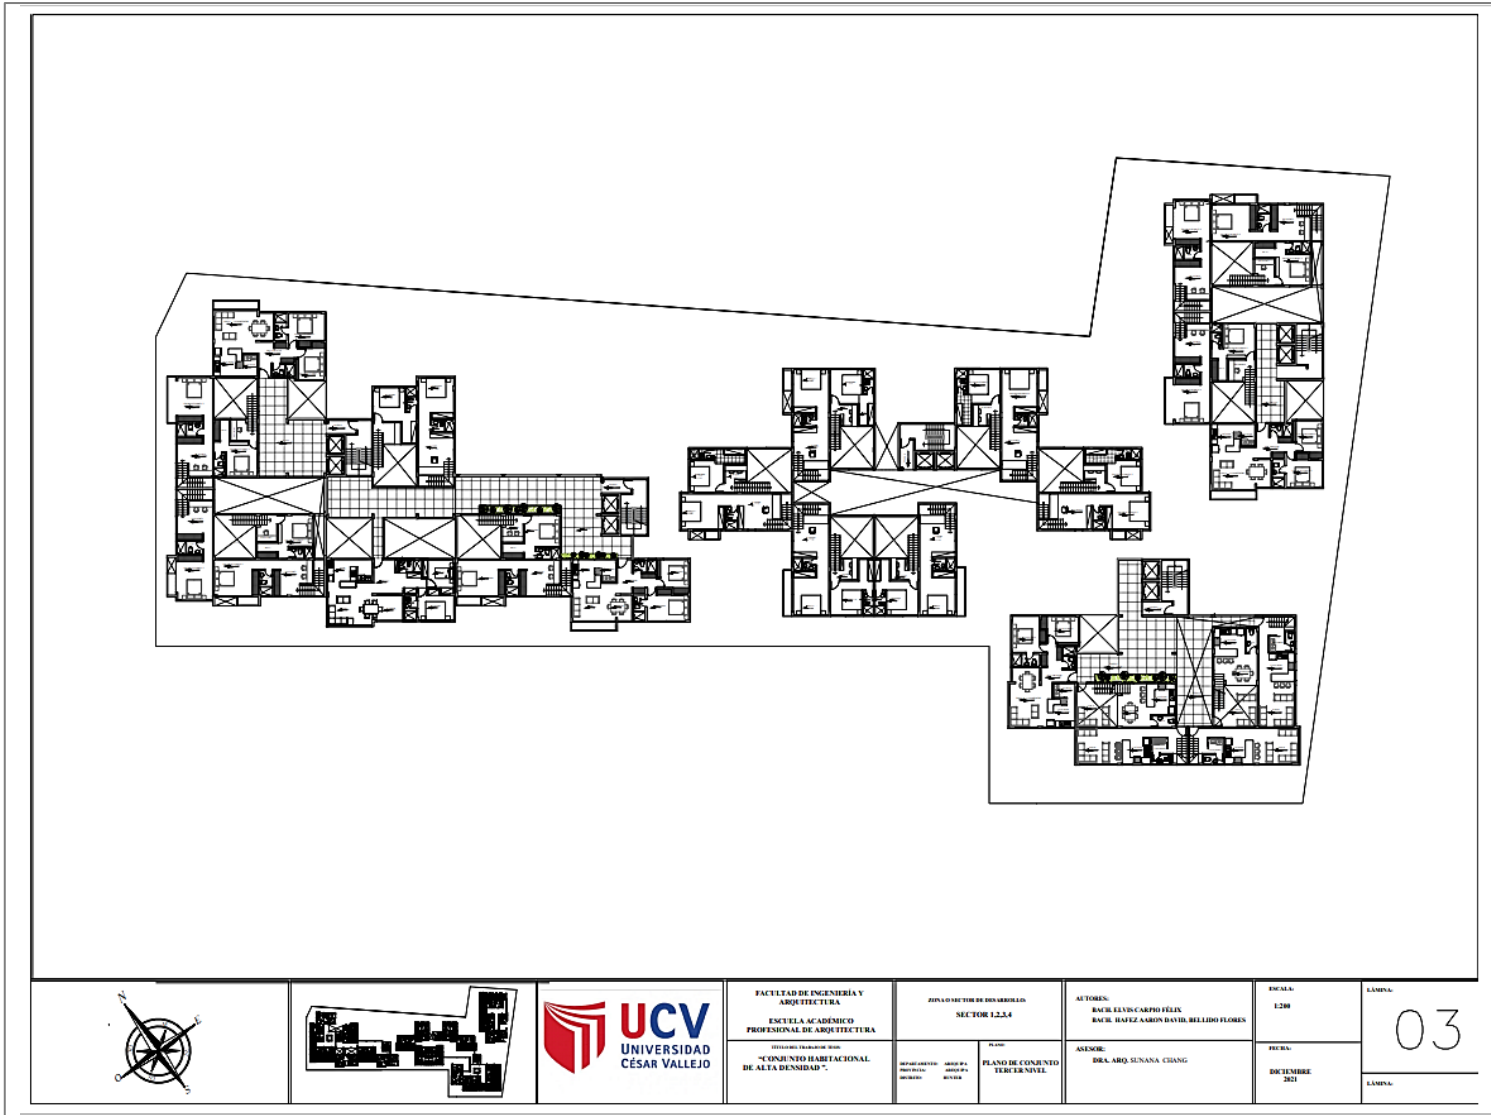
Plano General del Conjunto – Tercer Nivel 03
